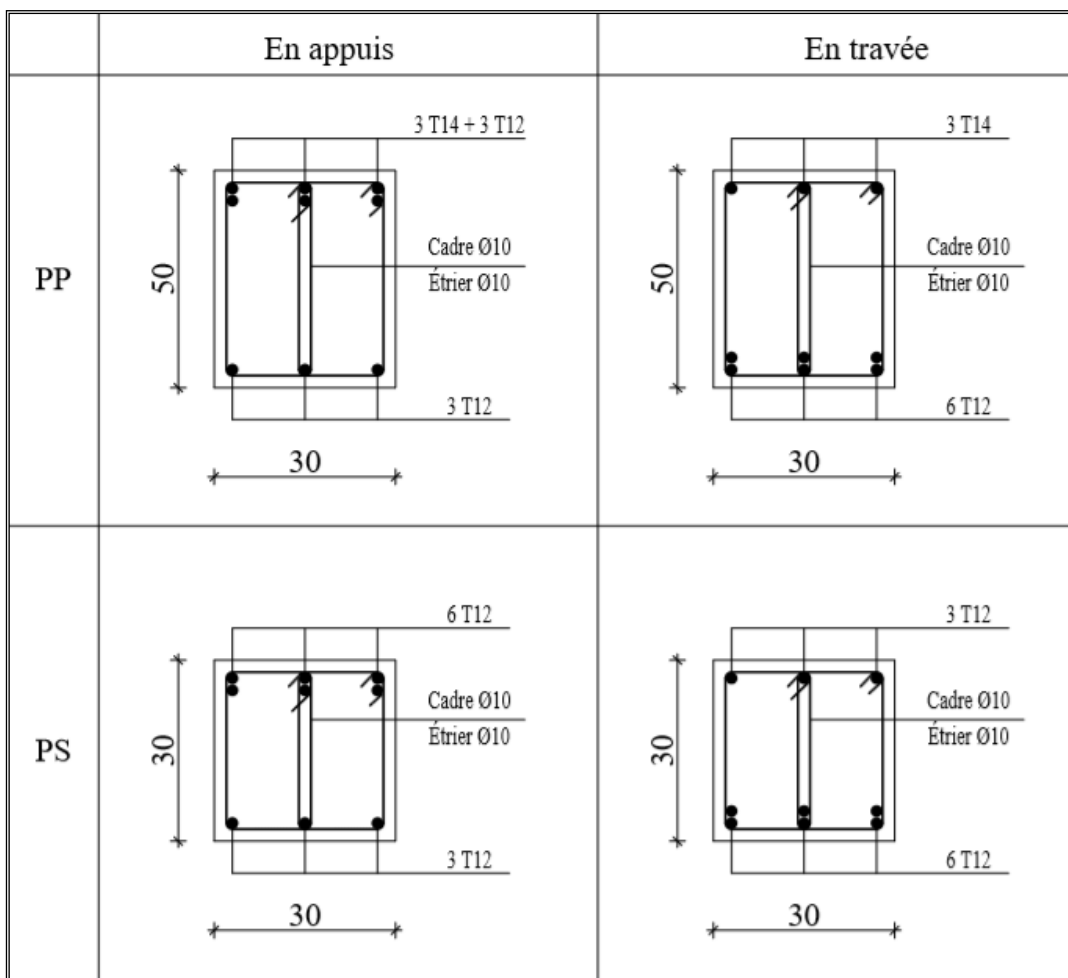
Section de ferrailage des poutres du plancher terrasse.
